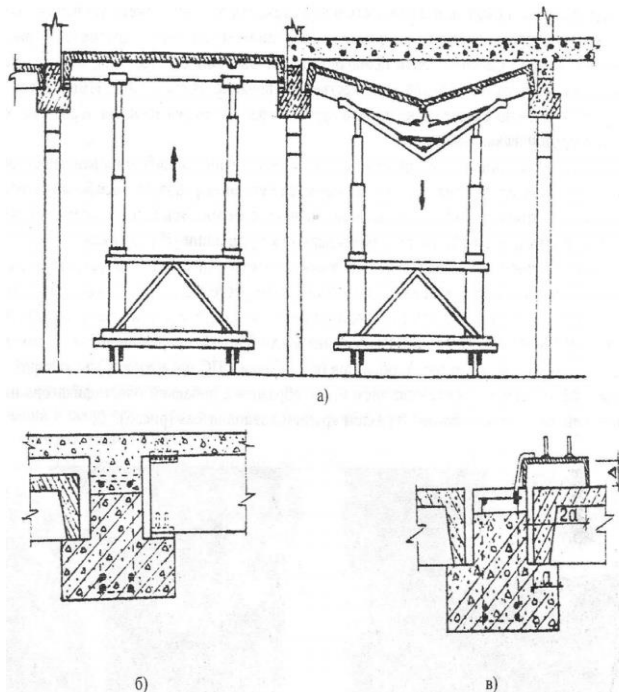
Способ замены сборного железобетонного перекрытия: а) общий вид; б) фрагмент опорного узла с закладной деталью; в) фрагмент опорного узла с опалубочным элементом
